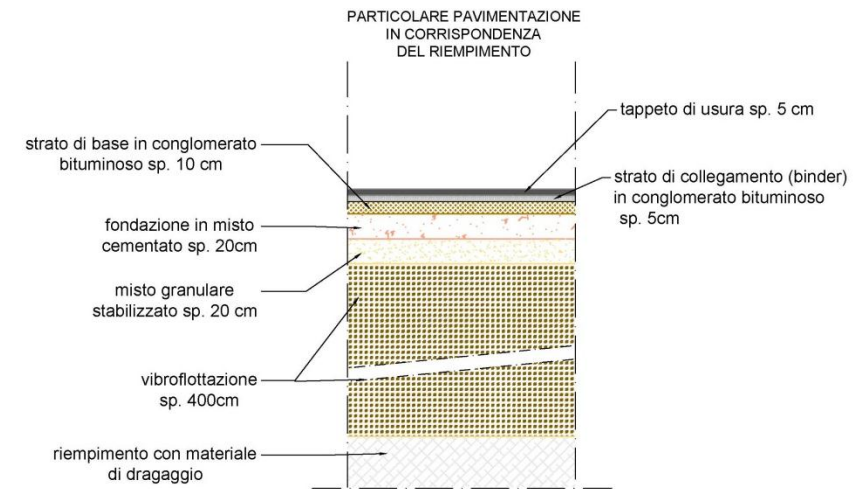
Pavimentazione - sezione tipo in corrispondenza del riempimento
